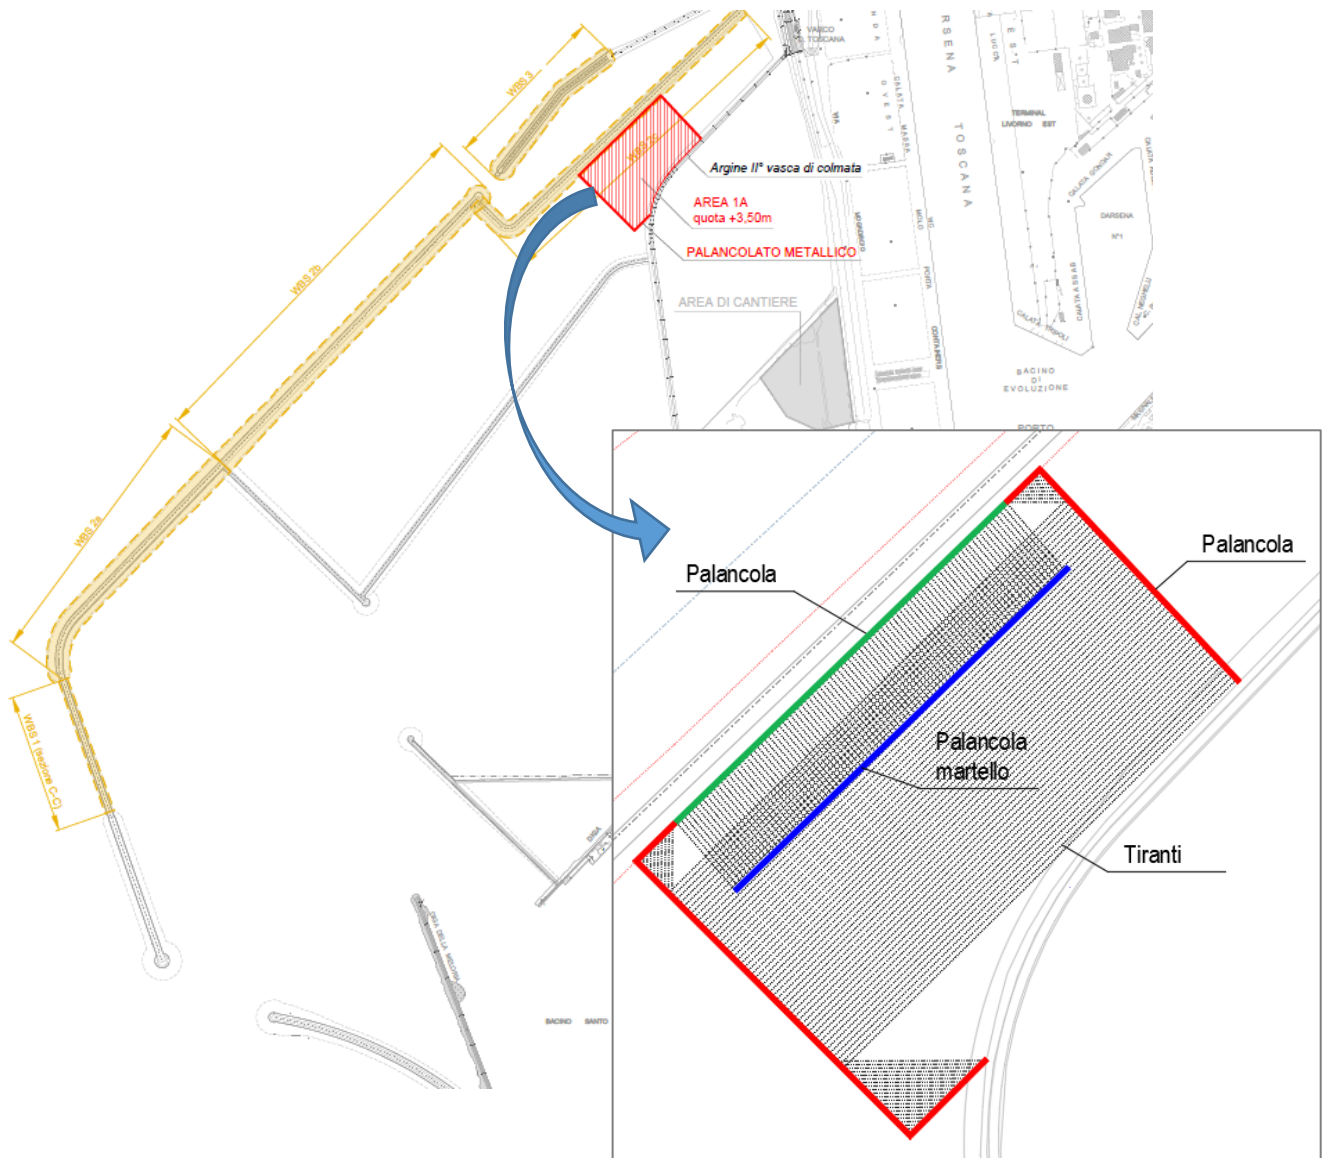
Individuazione dell'area e planimetria delle strutture
